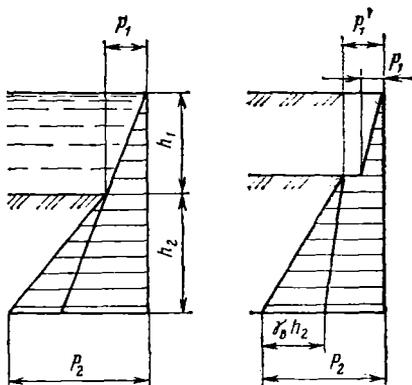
Эпюры давления на шпунтовые ограждения
